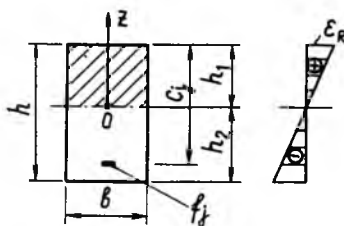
Поперечное сечение прямоугольного железобетонного элемента
